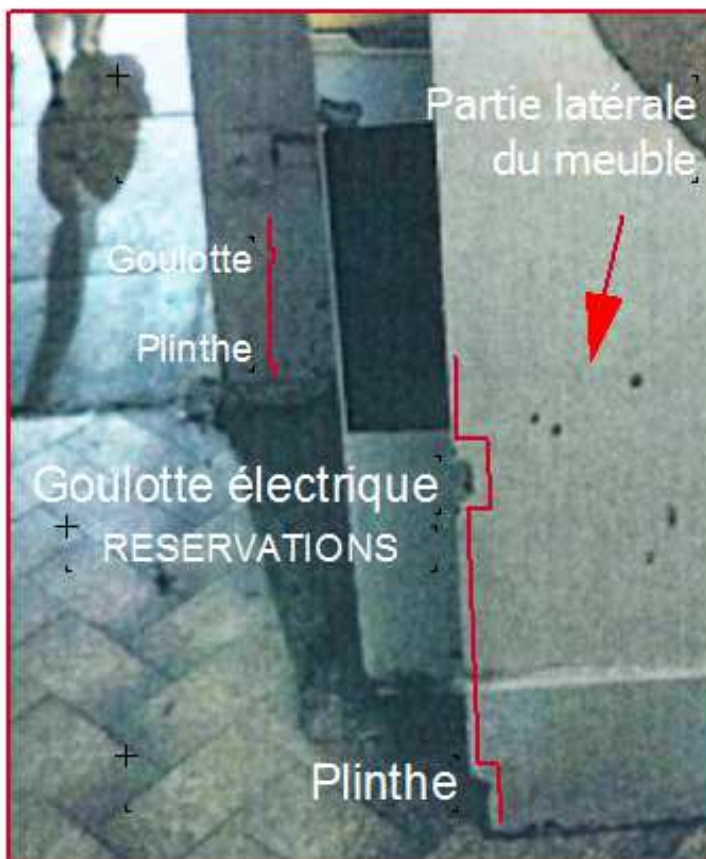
PV Constat d'huissier du 08/12/2021 [Alliance Droit]
